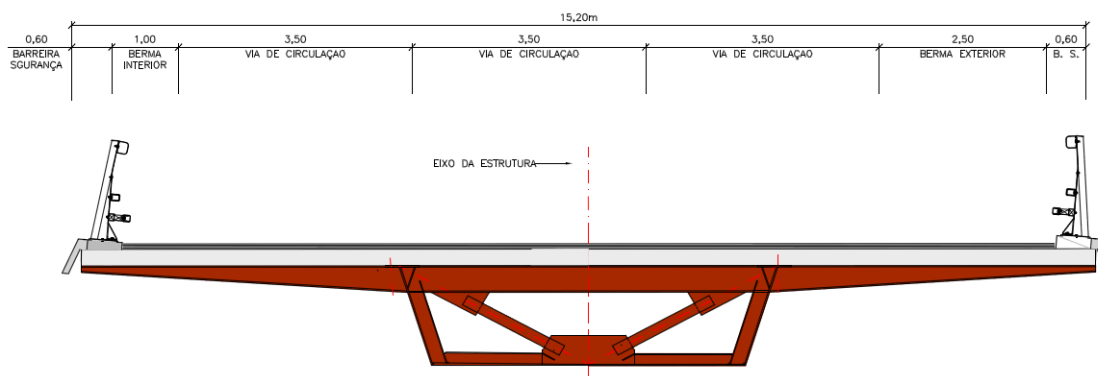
Secção transversal em caixão com travessa superior não escorada
